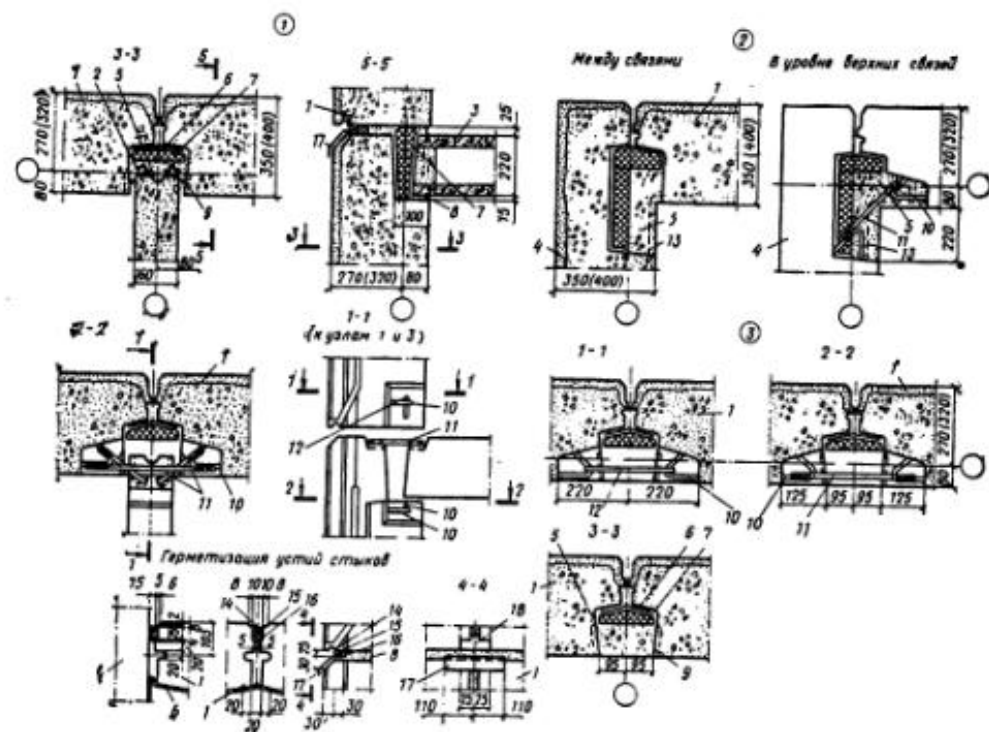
Узлы 1—3 сопряжения панелей стен: 1 — панель наружной стены (рядовая); 2 — панель внутренней стены; 3 — панель перекрытия; 4 — панель наружной стены (угловая); 5 — бетон замоноличивания класса В-20; 6 — воздухозащитная рулонная прокладка; 7 — утепляющий вкладыш; 8 — цементный раствор; 9 — шпунтовые рифления; 10 — петлевой арматурный выпуск; 11 — стальная накладка; 12 — стальная скоба; 13 — арматурная сетка на всю высоту стыка; 14 — защитное покрытие; 15 — герметизирующая мастика; 16 — упругая прокладка; 17 — водоотводящий фартук; 18 — дренажное отверстие (негерметизированный участок вертикального стыка)
